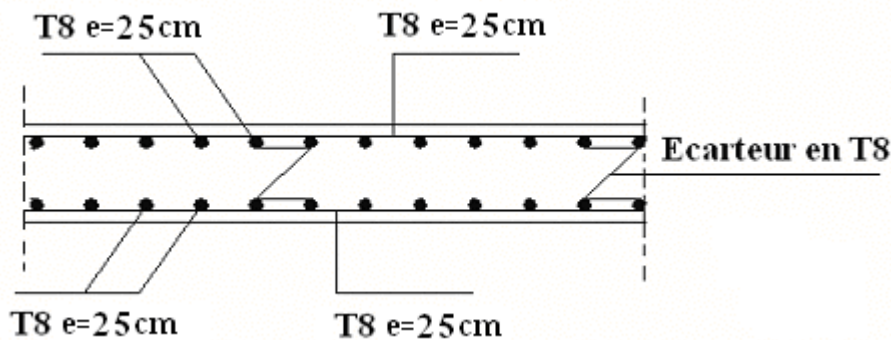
Disposition constructive des armatures de Plancher dalle pleine
